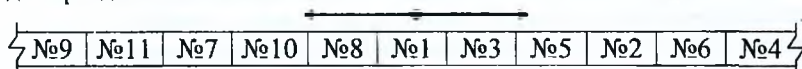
Схема разбивки старого фундамента на захватки при подводке нового фундамента:
